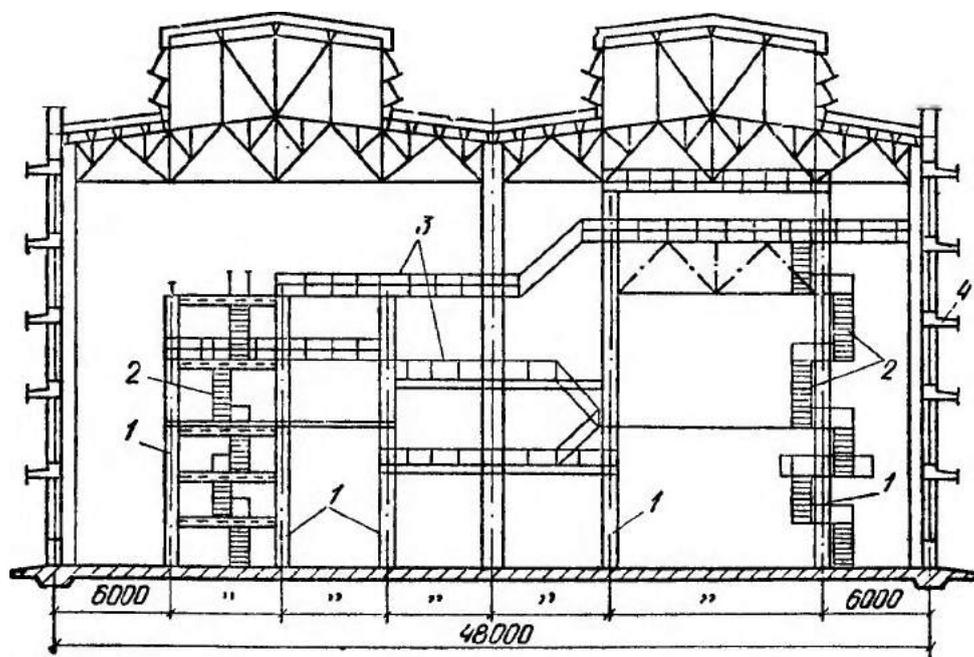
Разрез здания химической промышленности с этажерками — стойки каркаса этажерок; 2 — лестницы; 3 — площадки; 4 — солнцезащитные средства
